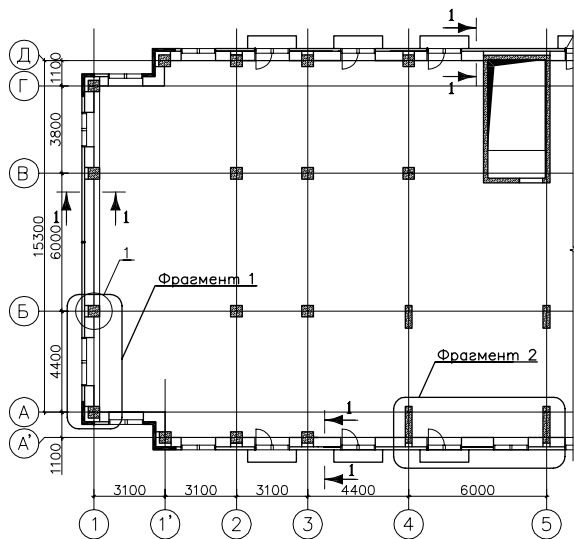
Фрагмент монолитного каркасного здания. План колонн, пилонов, стен
